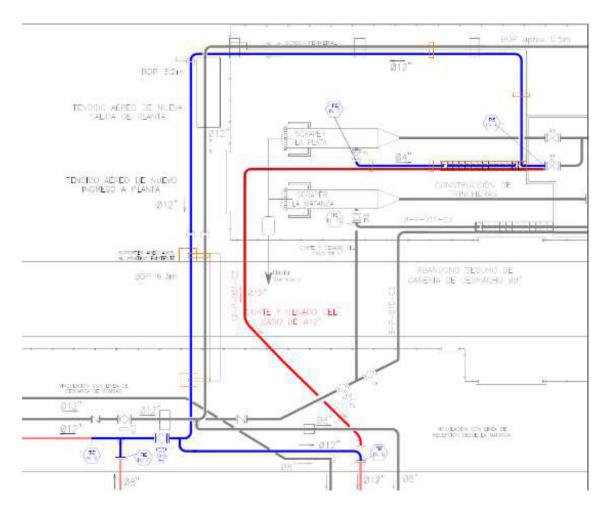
Esquema de reemplazo de la línea de ingreso a planta en color azul.
